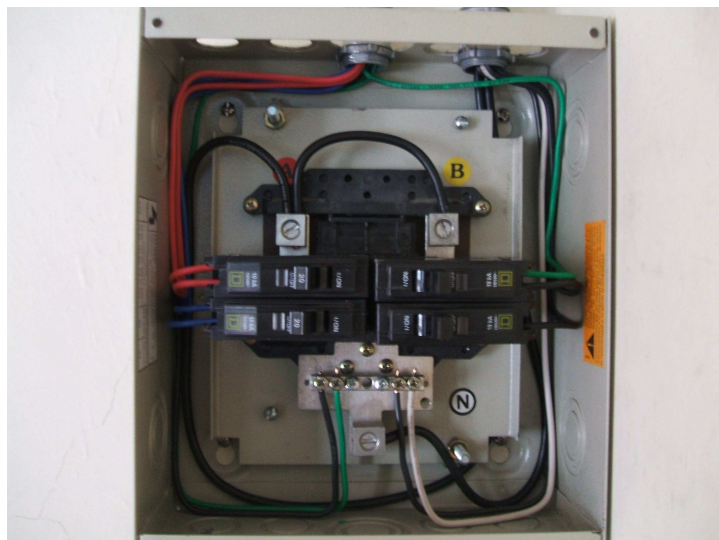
Estado actual de un sub-tablero de distribución.
